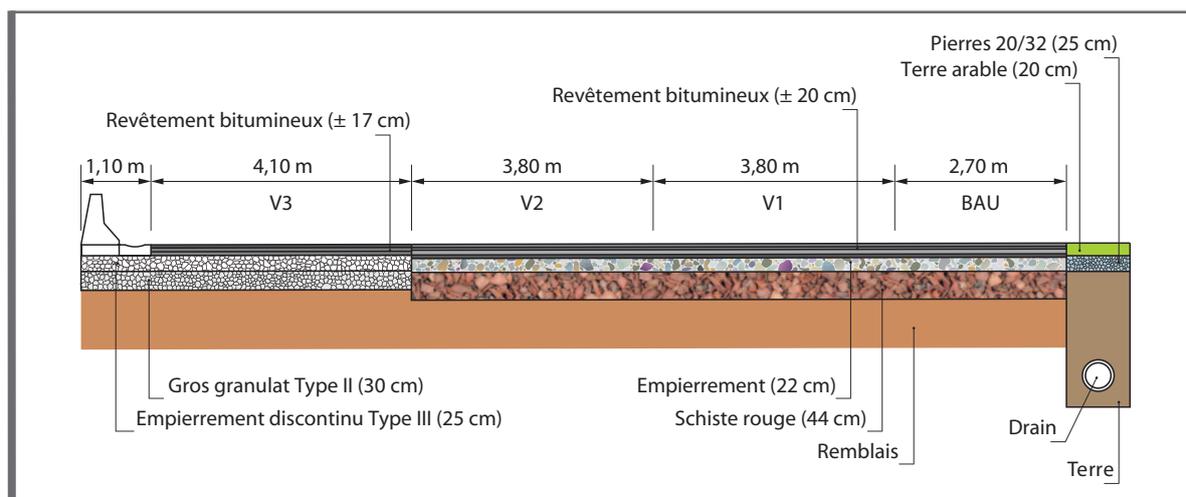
Exemple d'une autoroute avec problèmes de drainage
